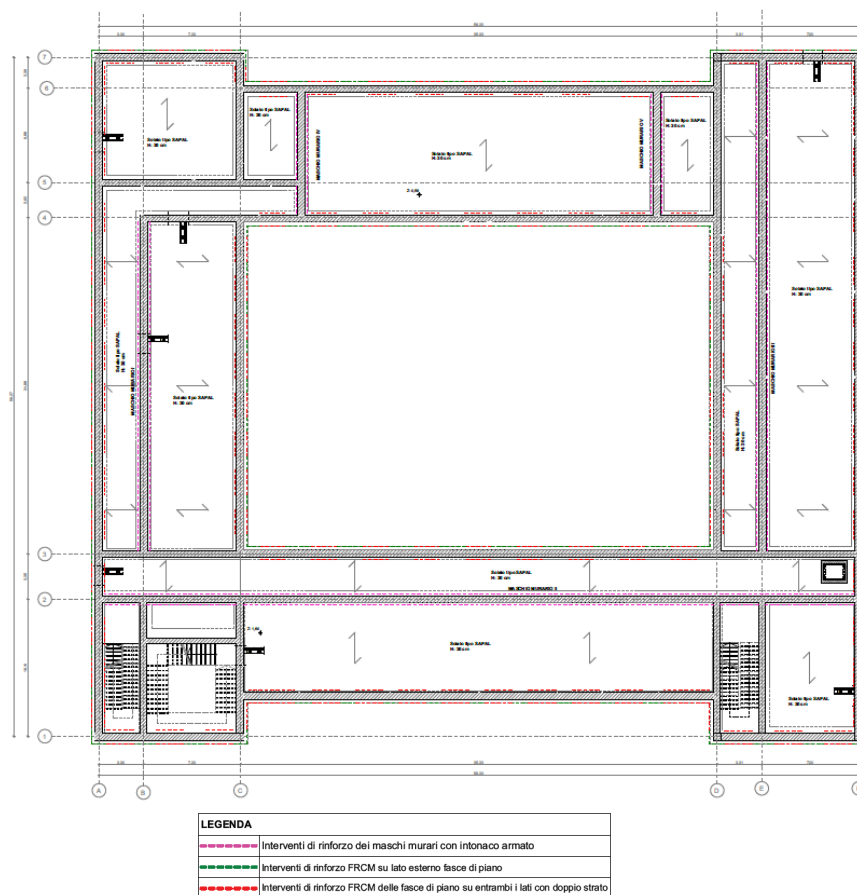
Pianta carpenteria stato di progetto - Piano terra
